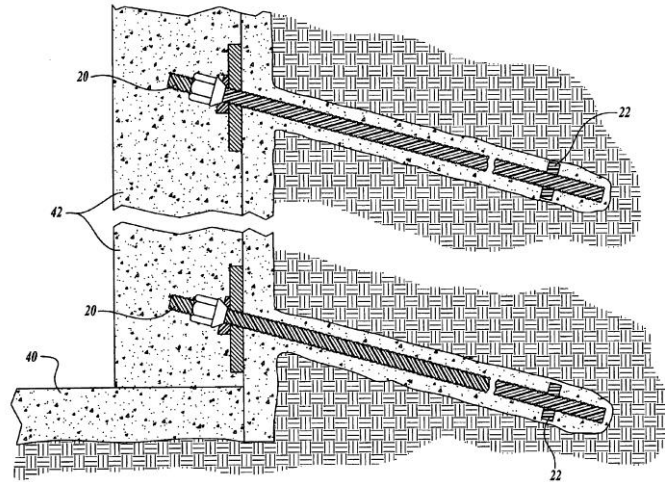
Soil Nailing*. Fuente: *Soil Nailing-A remedial construction technique to improve natural soil slopes, retaining walls, and embankments quality.* (2013)
